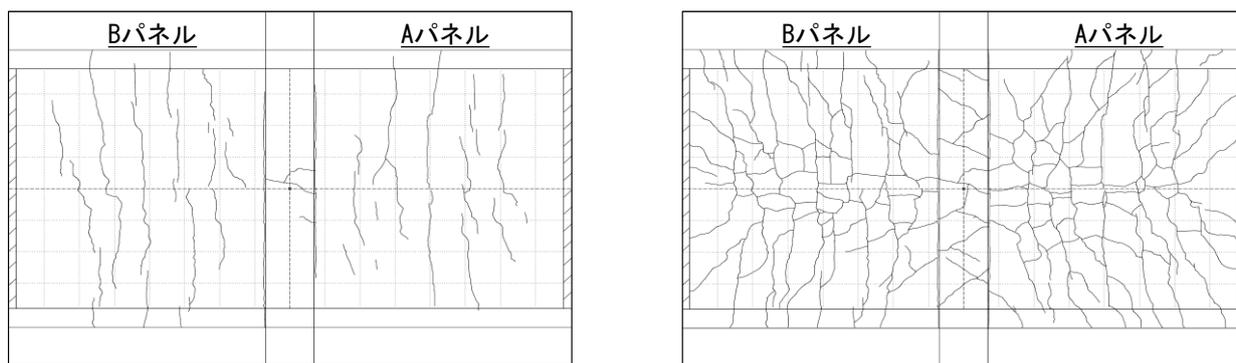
底面のひび割れ性状 (左 : STEP-1 終了時、右 : STEP-4 終了時)
